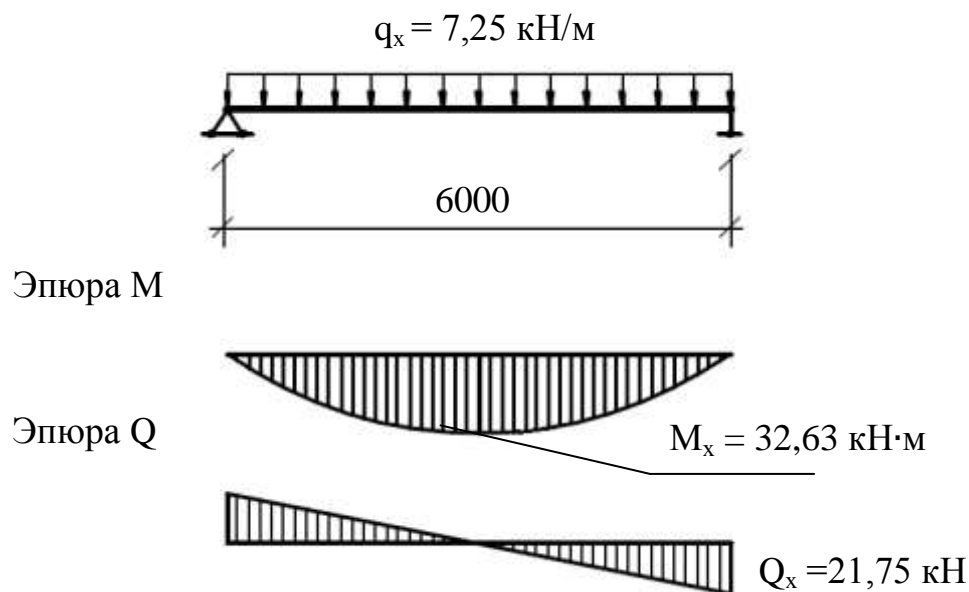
Расчетная схема прогона и эпюра моментов
